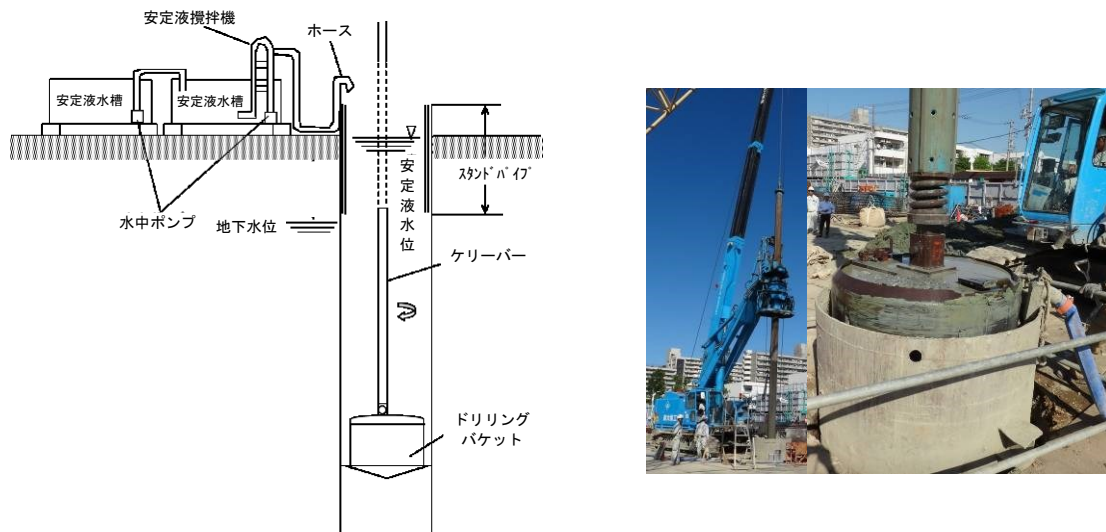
アースドリル工法施工概要図（左：施工模式,右：施工状況）
